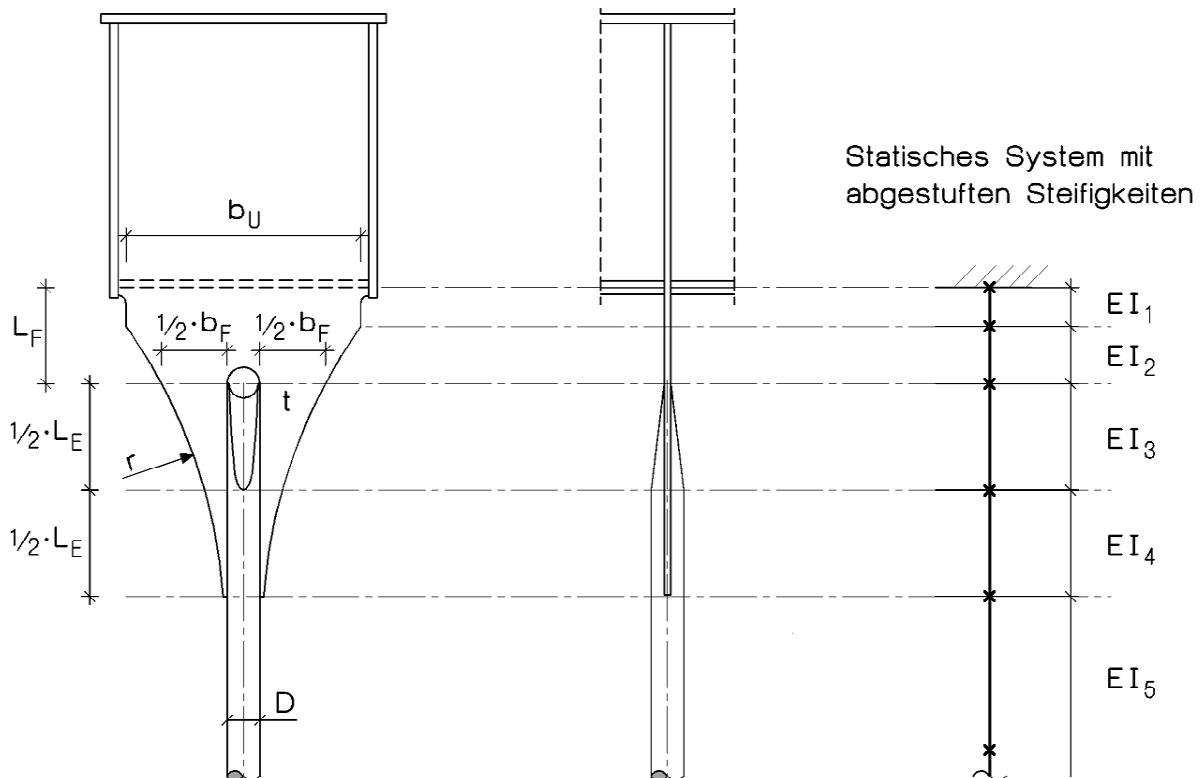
Geometrie des geschweißten Hängeranschlussbleches
